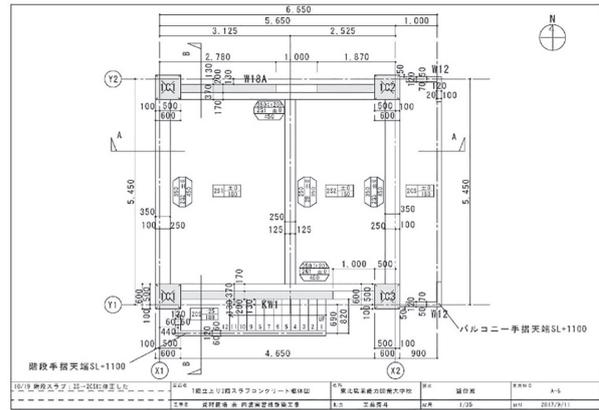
1階立上り2階スラブコンクリート躯体図(平面図) 平成29年度
